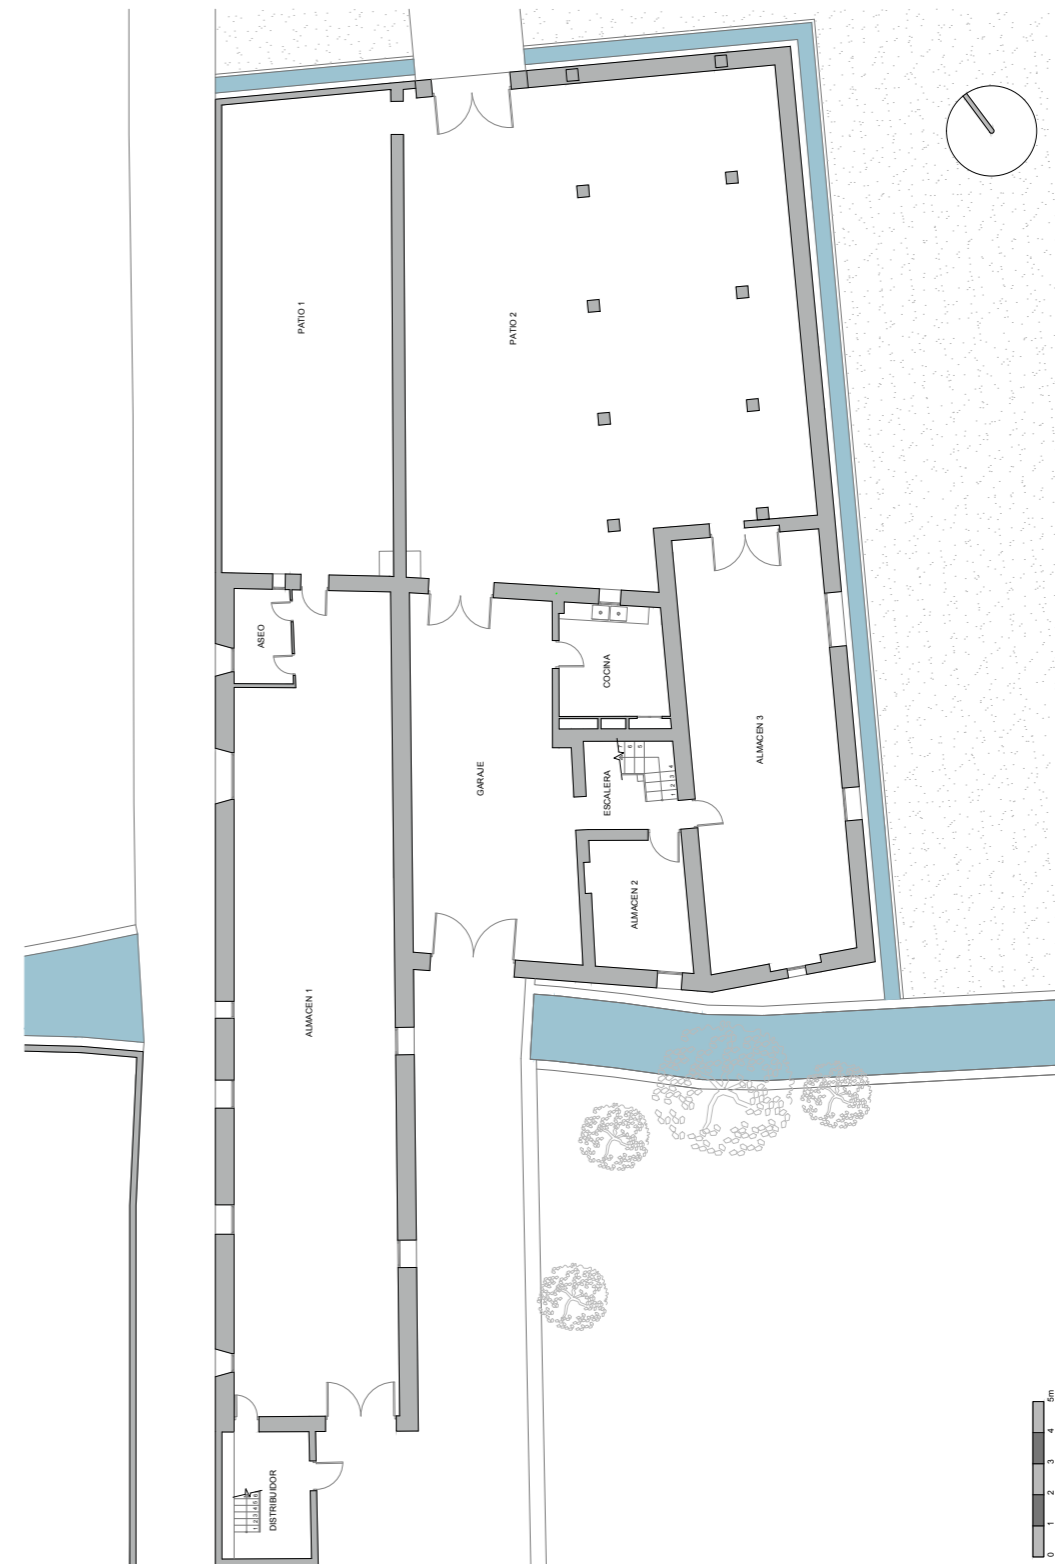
Plano de Planta Baja. Molí de Farinós. Autor Propio 2015
